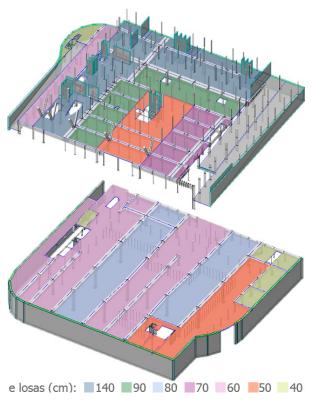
Modelo Estructural de Planta Baja. Zona Izquierda (arriba) y Zona Derecha (abajo).
